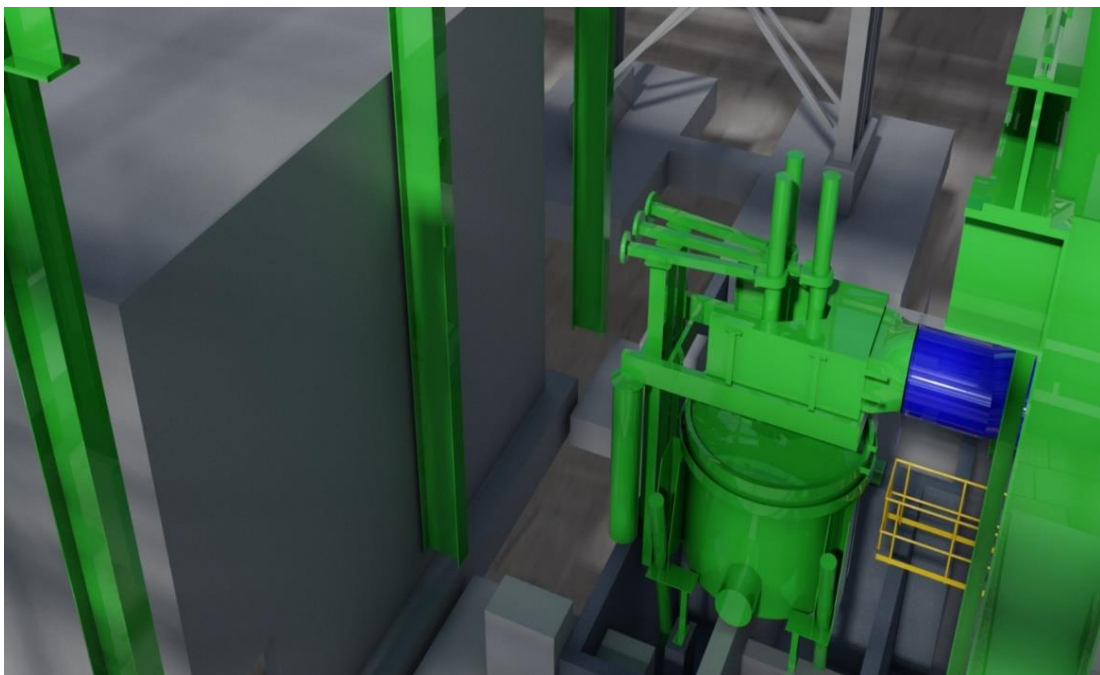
Trabajo Proyecto Autocad Plant 3D planta del proyecto.
